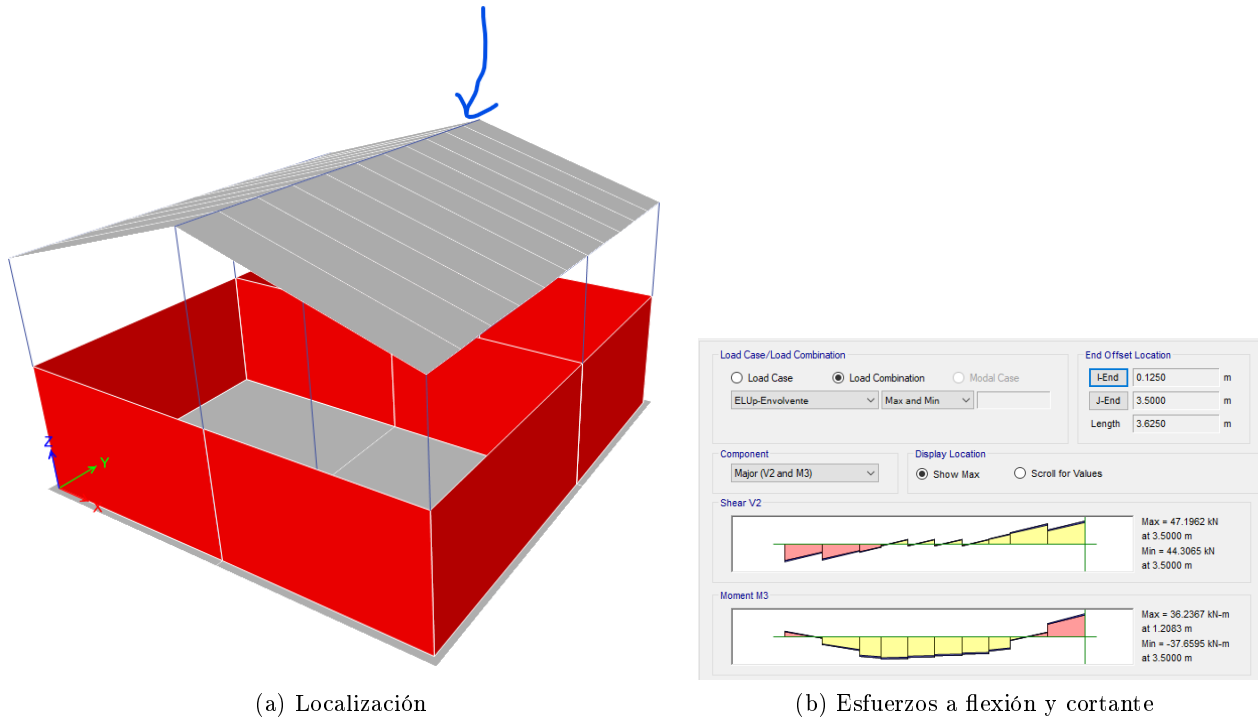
Esfuerzos sobre la viga de hormigón VIGA 02
